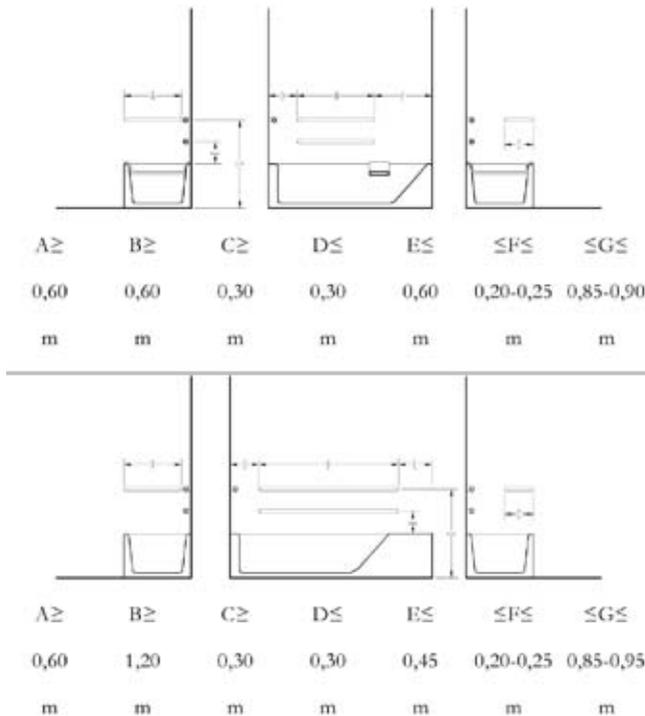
Localização e dimensões de barras de apoio junto à banheira acessível.
